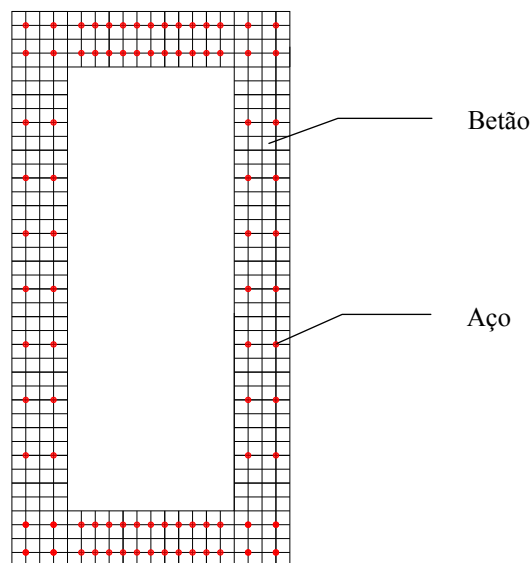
Exemplo da discretização da secção transversal de um pilar das pontes estudadas
